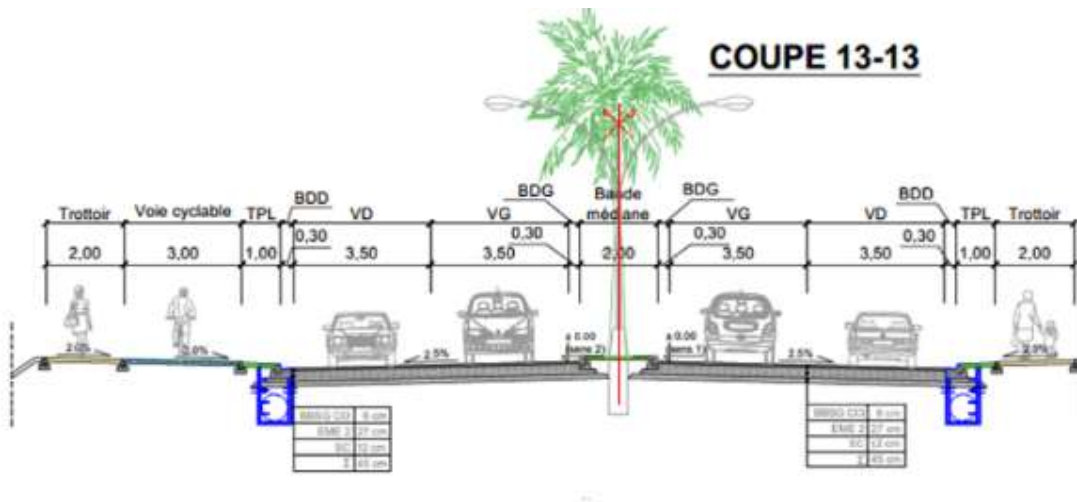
Profil en Travers – Section courante sur le boulevard de la Paix, partie Nord
